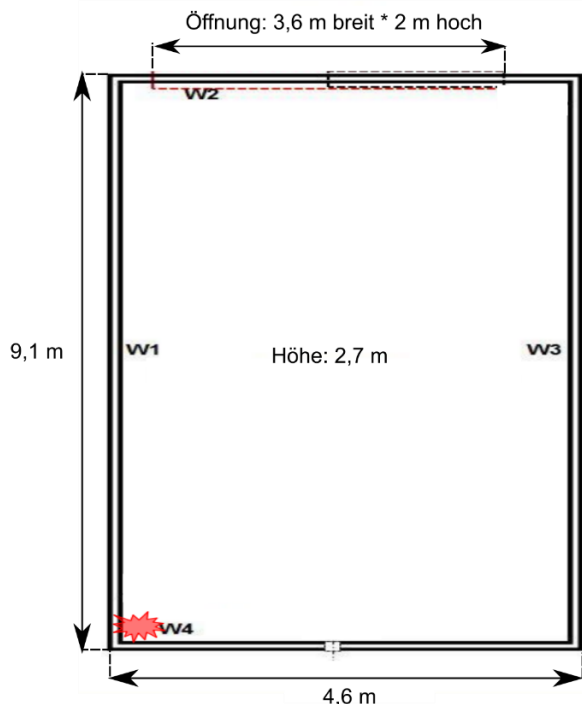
Grundriss des Versuchsraums von Test 1-3 (eigene Darstellung nach Su [14])
